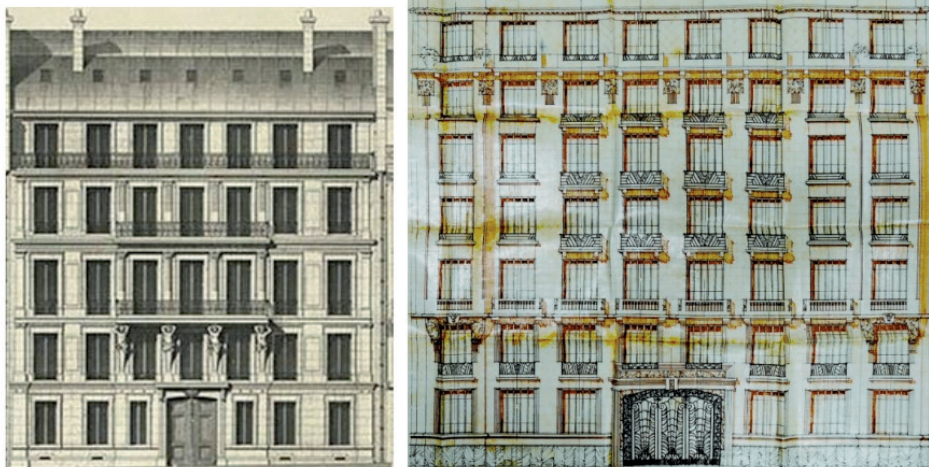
Fachada de ed. hausmaniano e do ed. Tamararé (projeto)
